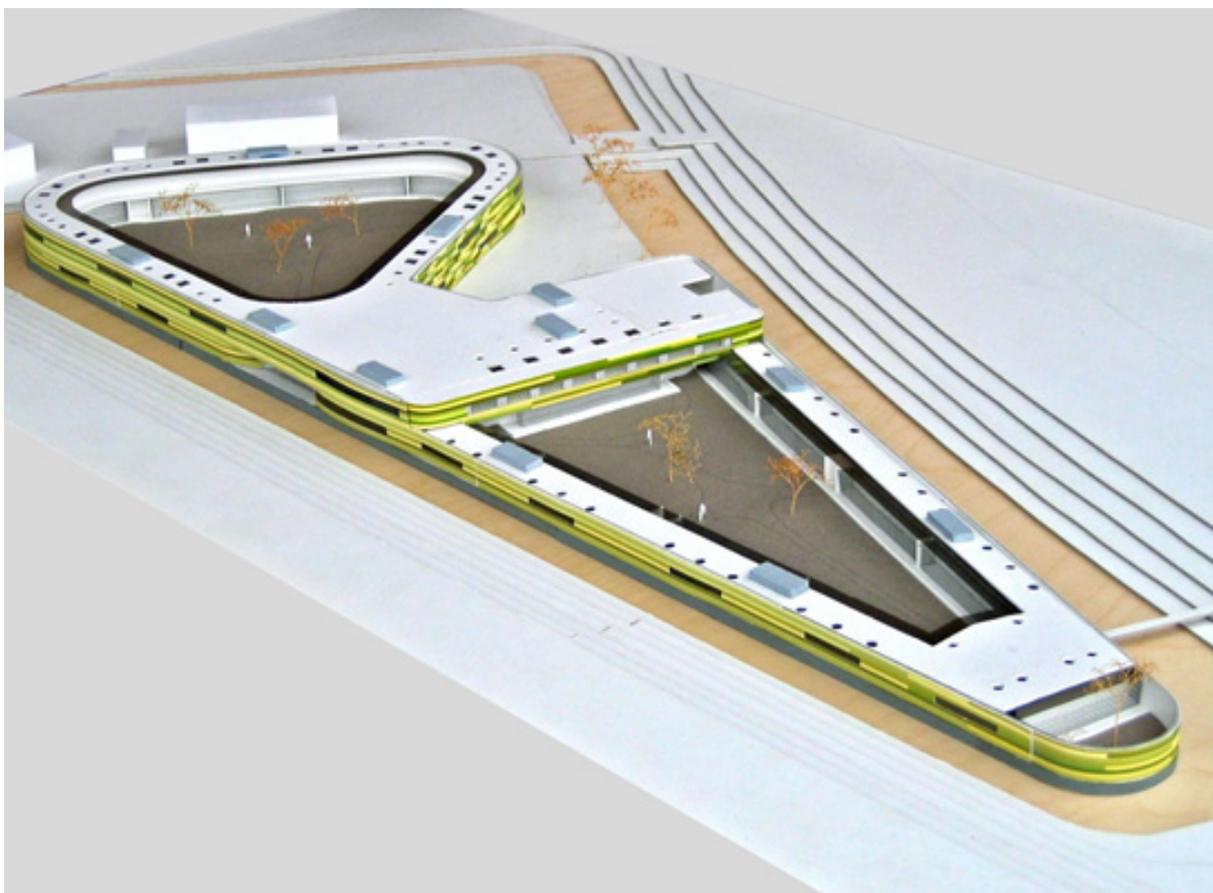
Maquete do projeto do Animal Refuge Center - Fonte: Archdaily
